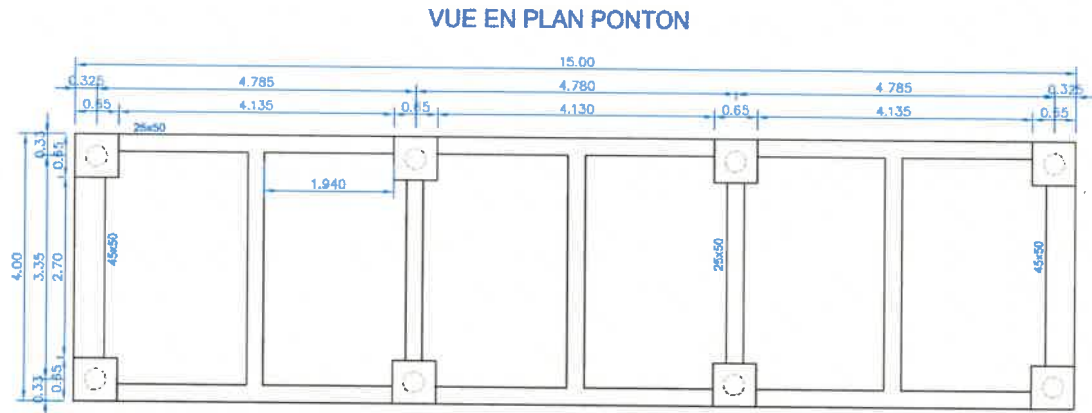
plan masse du ponton existant – source DOE ETPO Guadeloupe juillet 2012
